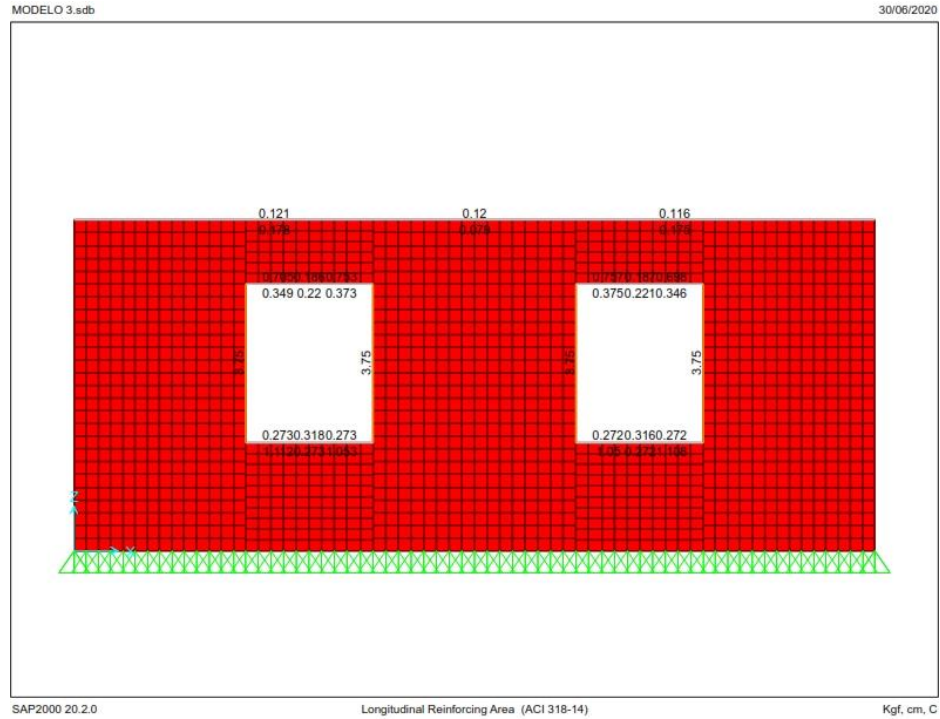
Áreas de Acero longitudinal pared Posterior - Modelo III
